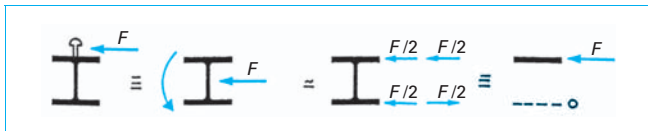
Reprise par cisaillement et flexion des ailes de la poutre transversale de la résultante $F = F_{Rd3}$ transmise par les connecteurs disposés sur cette poutre
